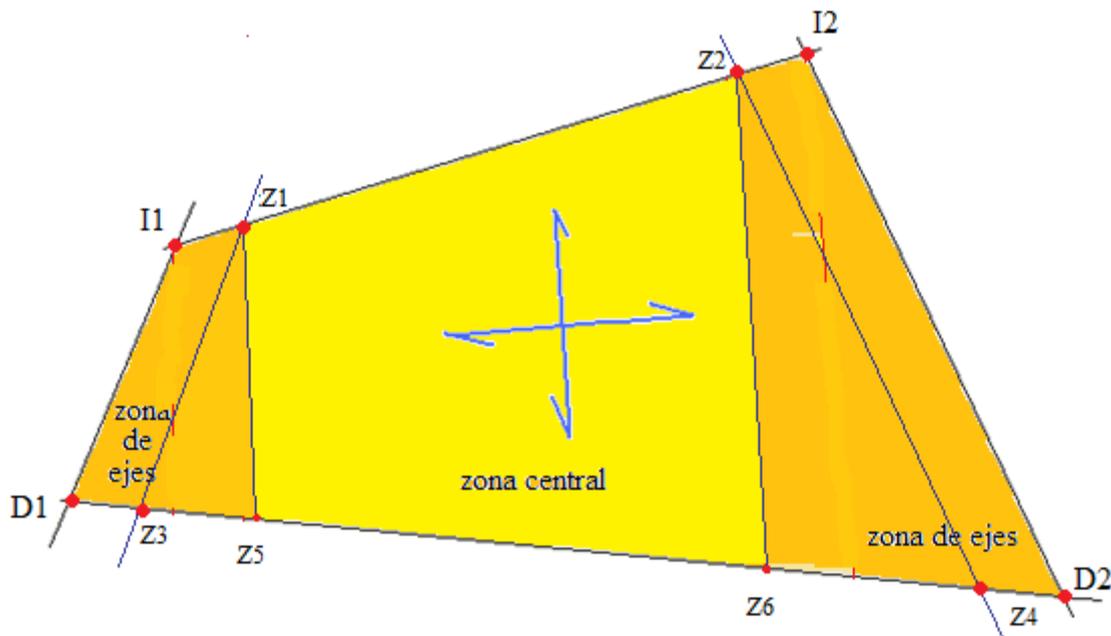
definición de las bandas de armado transversales. Zona central y zona de ejes.
